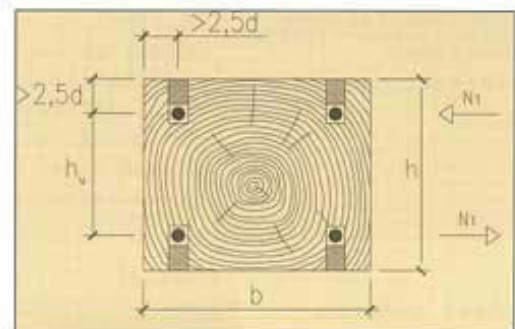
Schema delle azioni agenti sulla sezione della trave (sezione trasversale).
